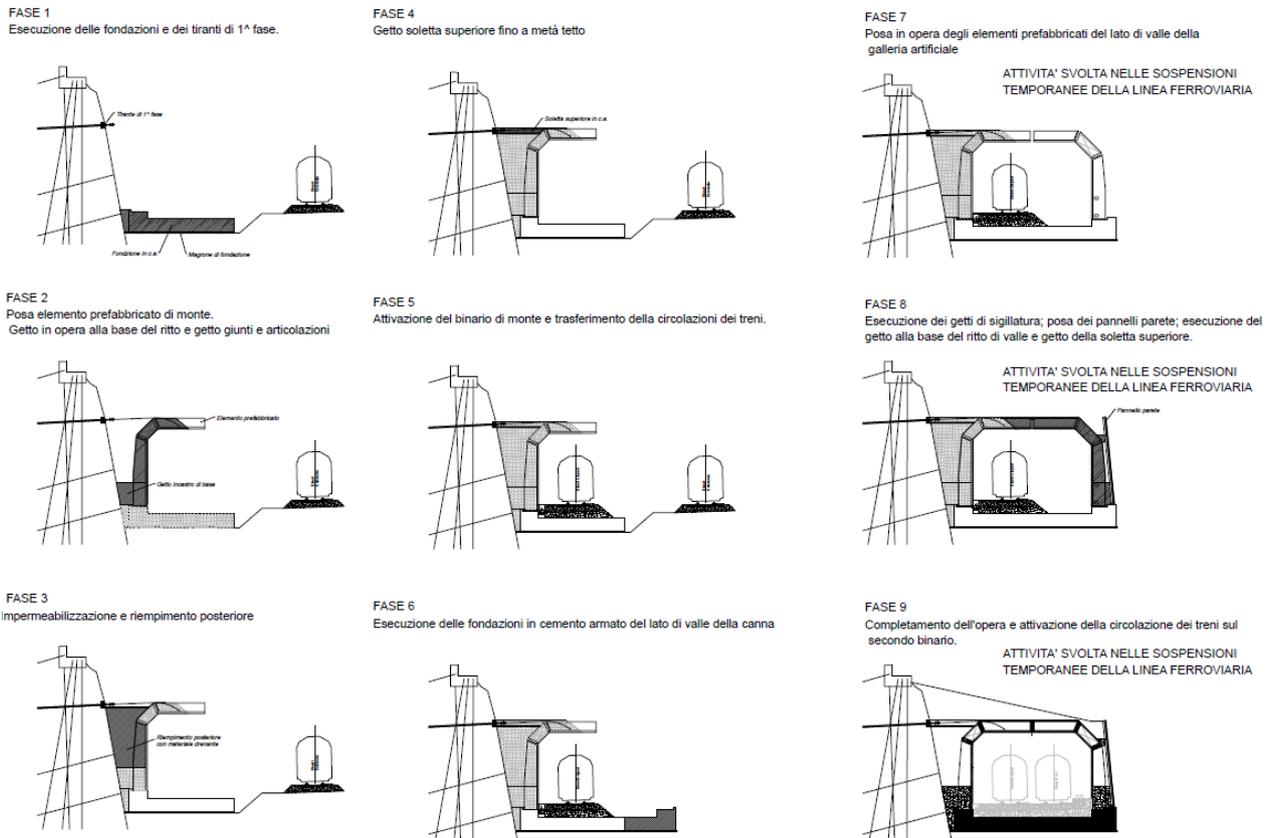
Schema tipo delle fasi necessarie alla realizzazione della struttura in 2 fasi.
